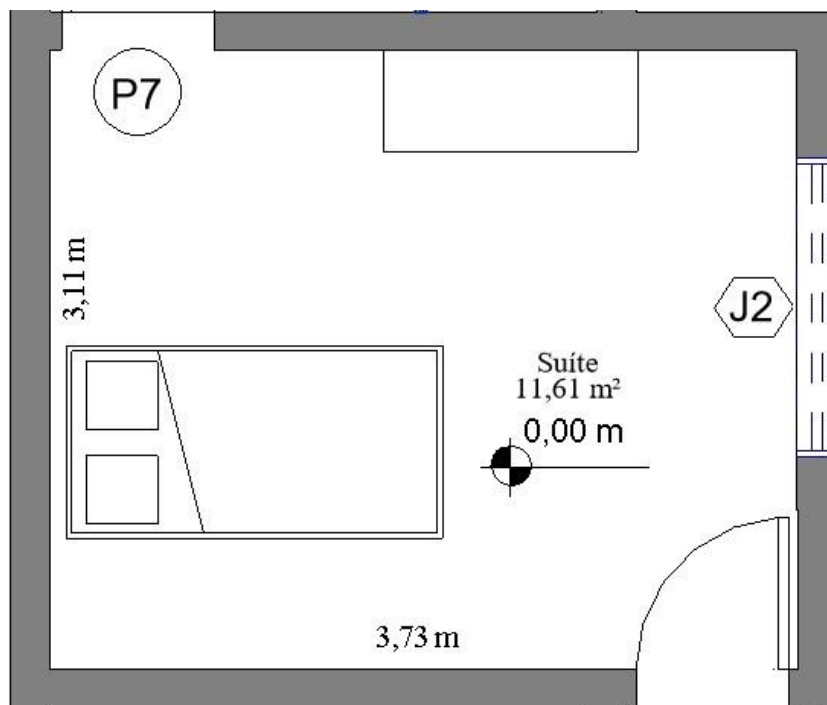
Vista da Suíte em planta baixa (Fonte: própria autora)
